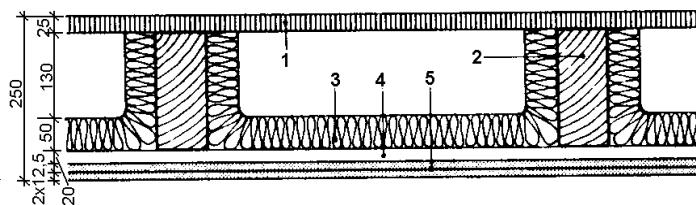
Деревянные балочные перекрытия. Вариант IV.
